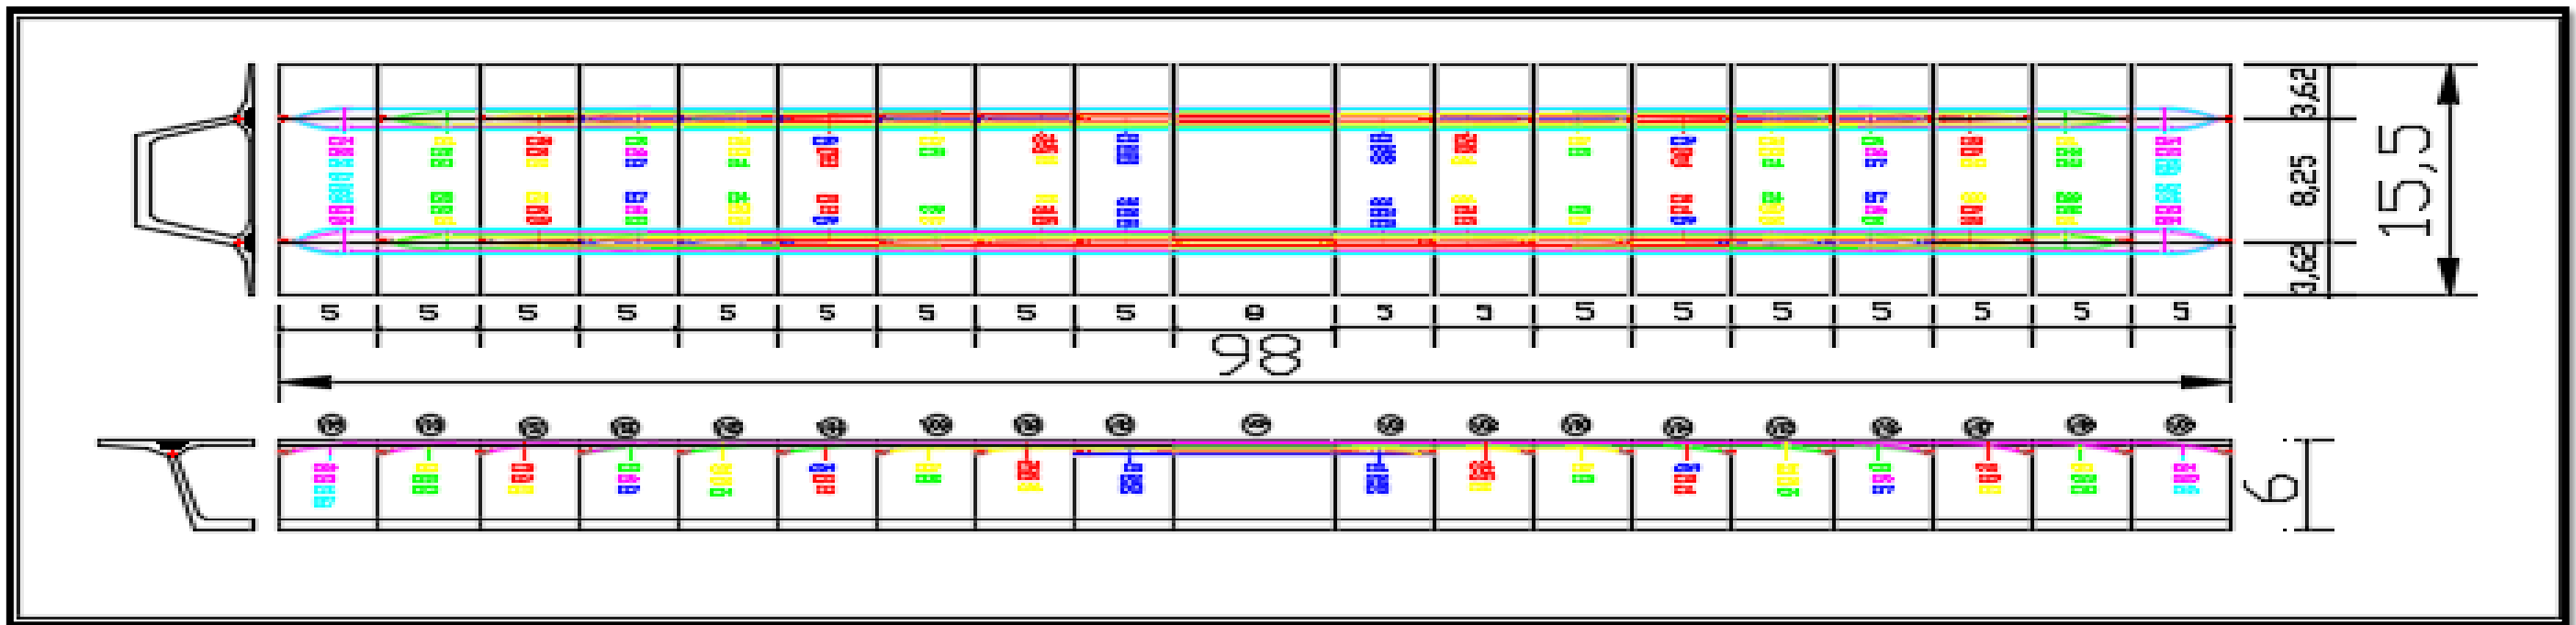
Tracé en plan et élévation des câbles des fléaux
